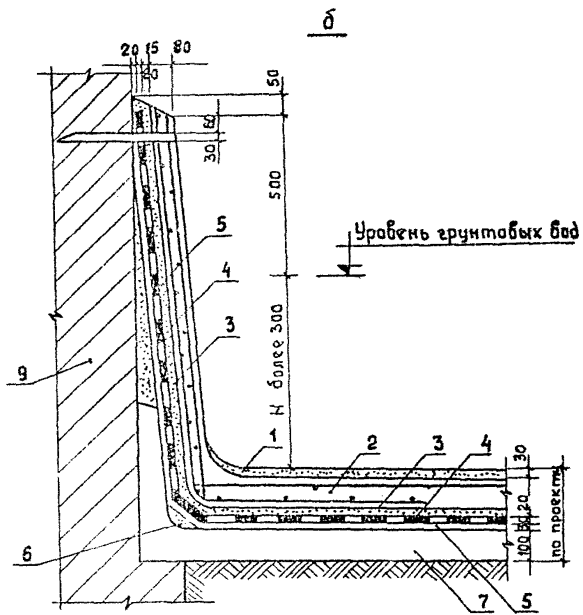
Конструкция гидроизоляции по грунту и существующему бетонному полу при уровне грунтовых вод (H) более 500 мм и для помещений высотой менее 1,7 м при H более 300 мм
